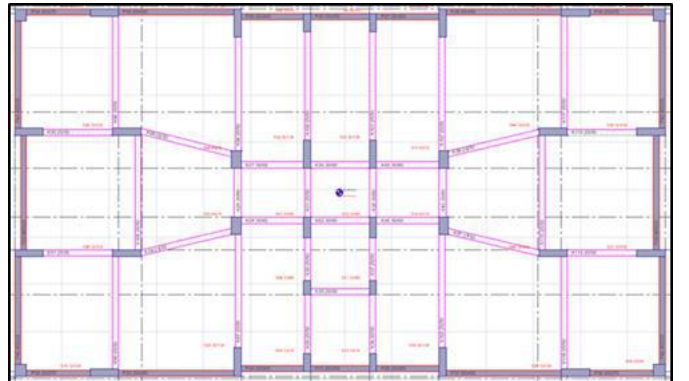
Yapımı tamamlanmış olan perdeli çerçevesel P1 planını oluşturan mevcut yapı planı
